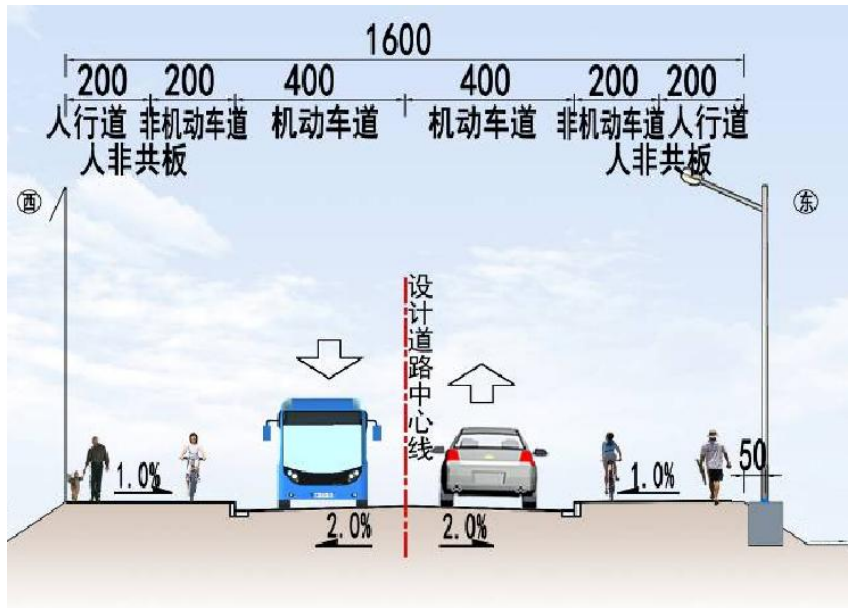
连云港市市区景区连接线南岛线段横断面图
